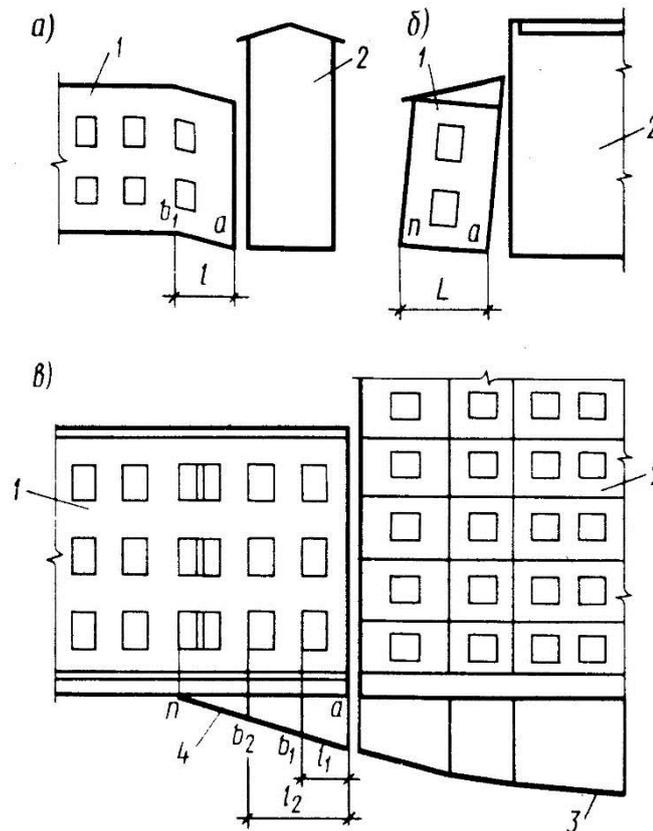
Схема к определению крена здания и перекоса его конструкций в результате развития дополнительной осадки:
